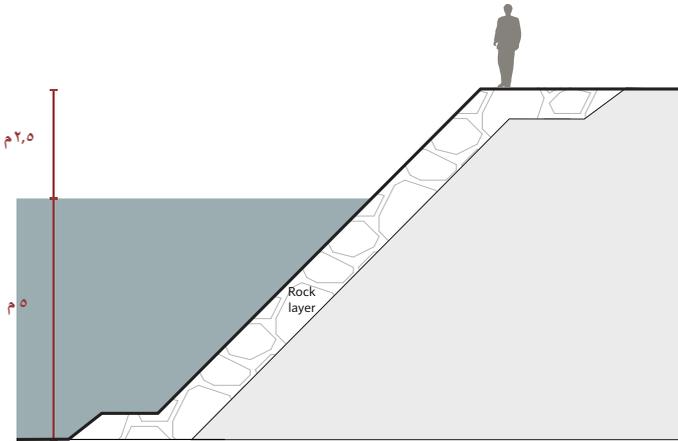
أمثلة للطابع العام للممشى الساحلي
